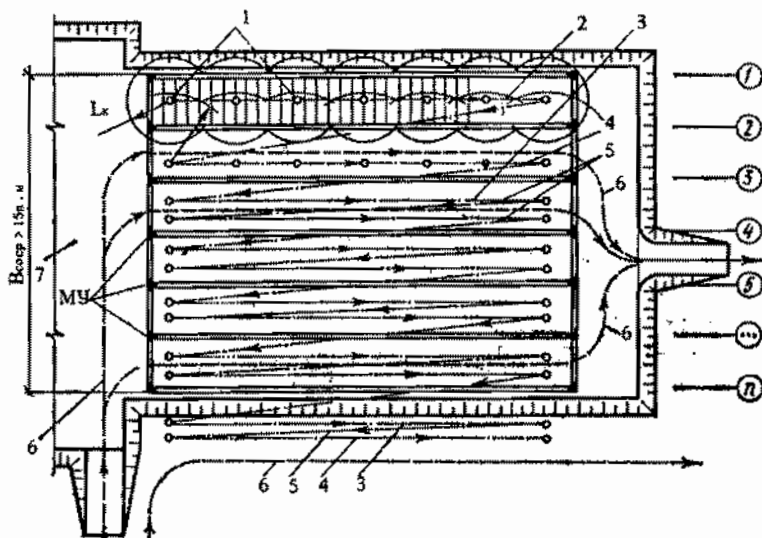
Принципиальная схема монтажа горизонтального отстойника: 1 - стойки крана; 2 - ось движения крана при монтаже стеновых панелей первой секции (коридора); 3 - то же, второй и последующих секций; 4 - ось движения крана при монтаже плит покрытия; 5 - обратный ход крана; 6 - ось движения транспорта; 7 - котлован для здания фильтров; МУ - монолитные участки;  $L_k$  - вылет крюка крана при монтаже панелей и плит
